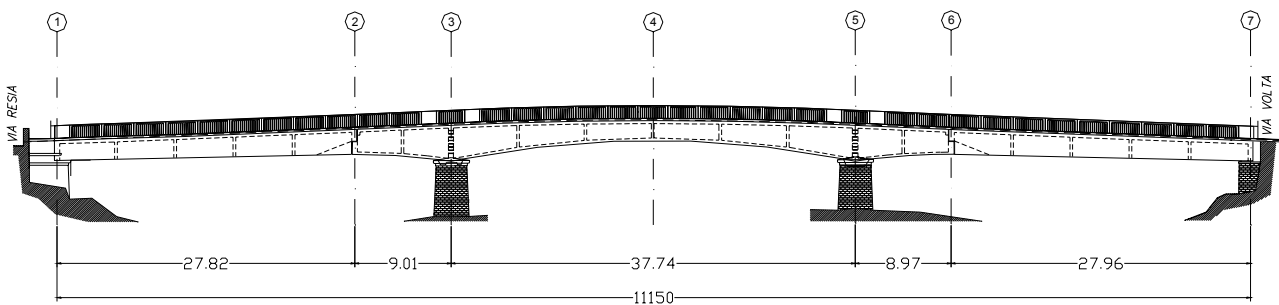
Sezione longitudinale dell'impalcato: stato di fatto
